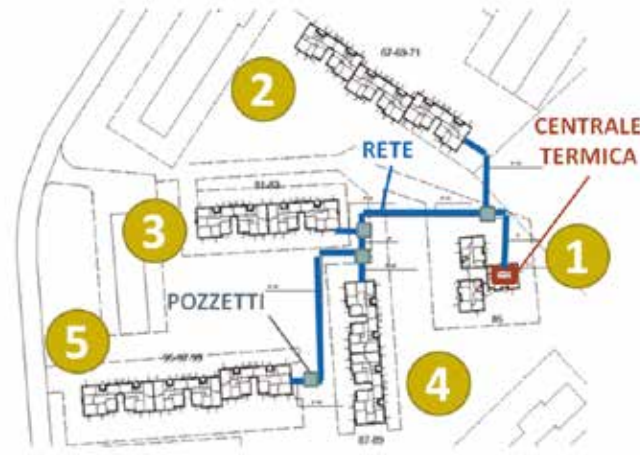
Disposizione planimetrica dei 5 edifici oggetto della riqualificazione energetica.
